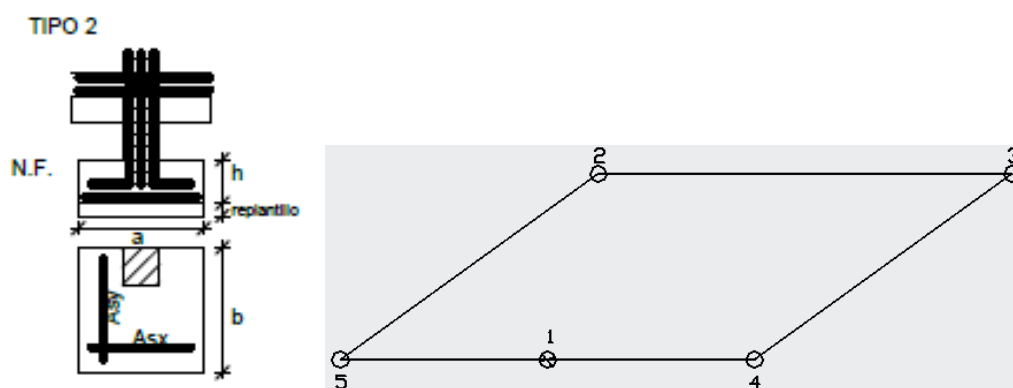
Zapata tipo 2 (lindero) y puntos de deformación.
